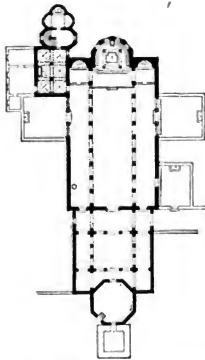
Basilika und Baptisterium zu Parenzo. (Grundriss.)
